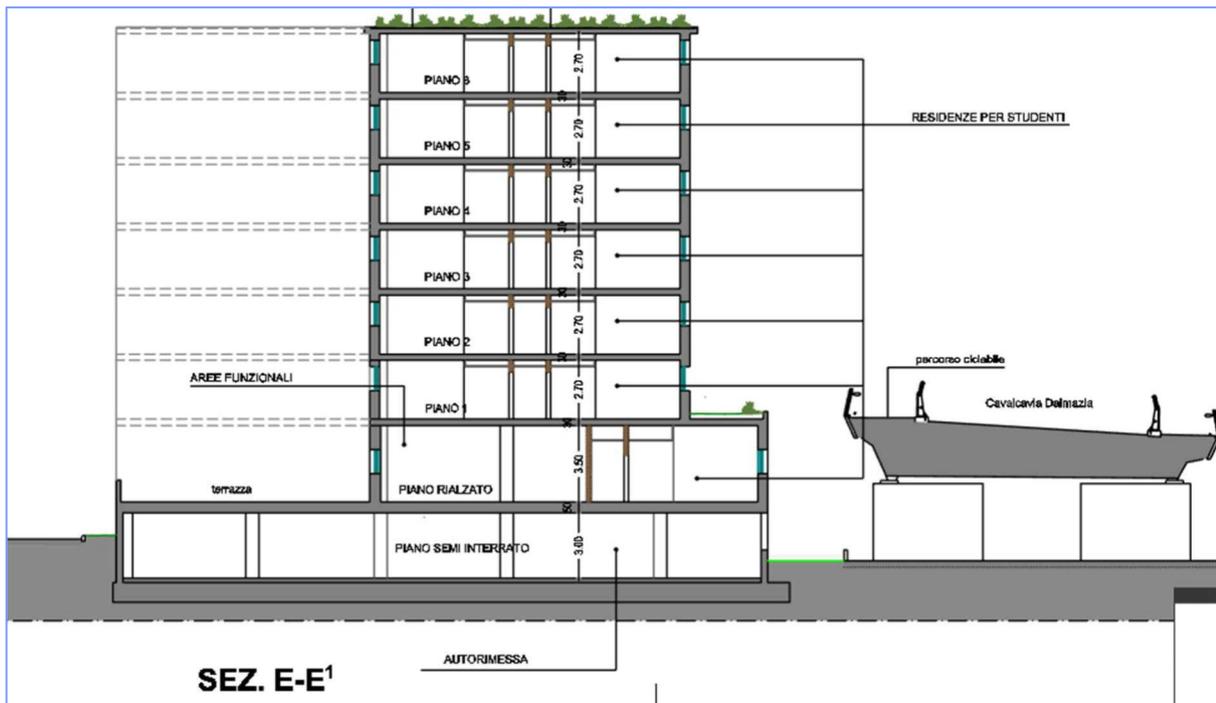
sezione tipo di progetto dell'edificio B (E-E¹) - mutata la destinazione del piano rialzato
